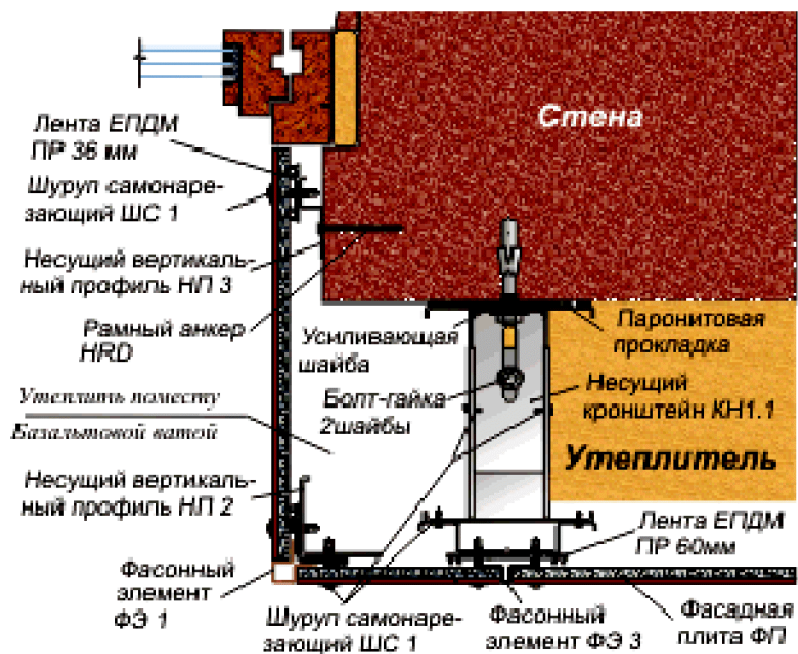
Крепления фасадной плиты на угол здания (2-й вариант)
